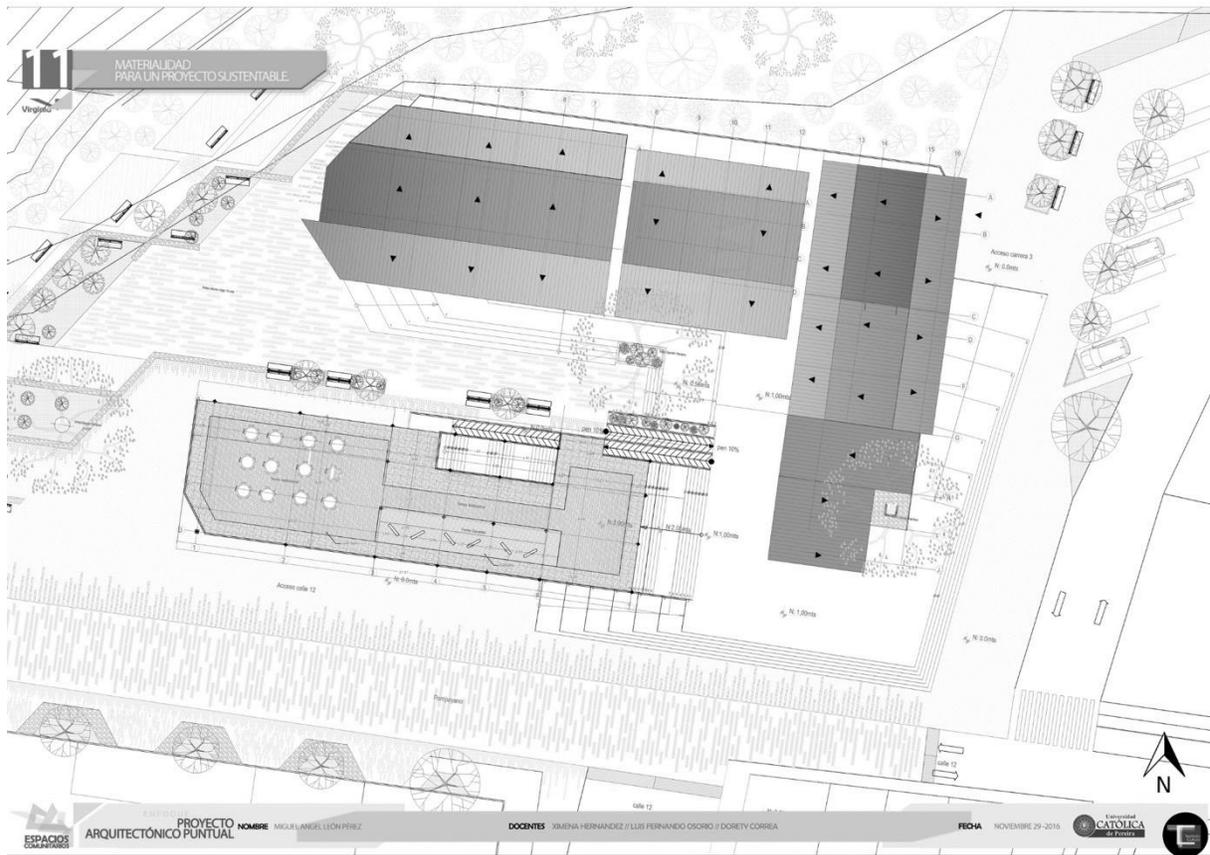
Segunda planta. Fuente: elaboración propia.
